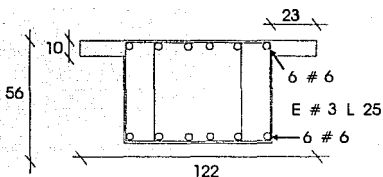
SECCION AL CENTRO DEL CLARO DE LAS TRAVES DE RIGIDEZ
